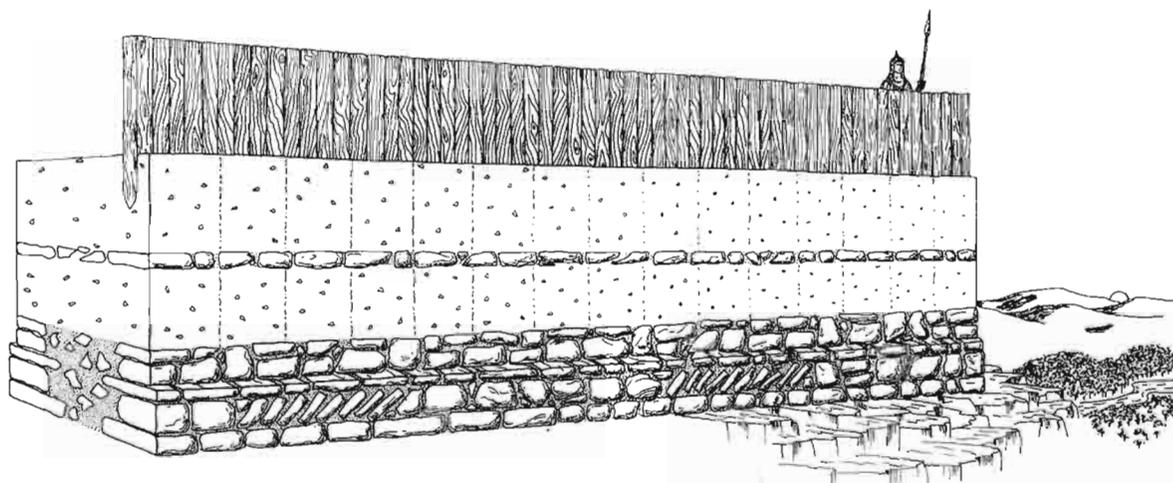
Reconstrucción del muro oriental. Zócalo de sillares y elevación de tapial con refuerzo de piedras.
